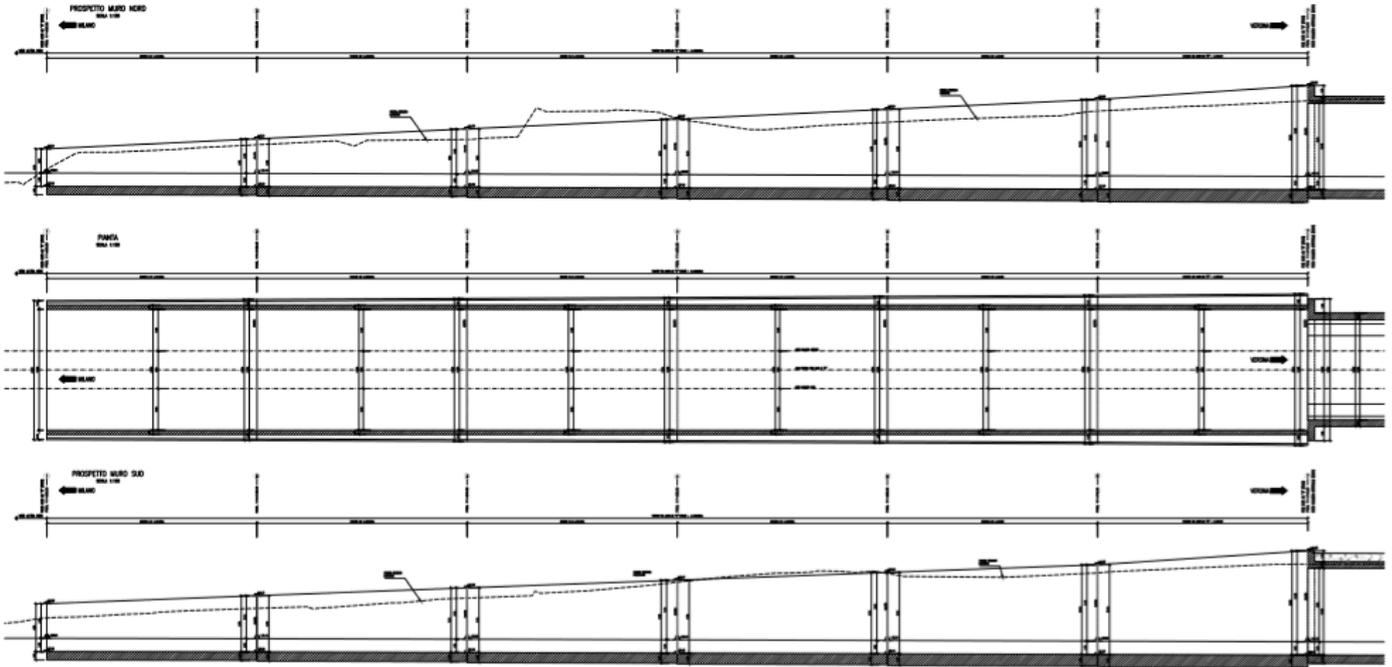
Trincea tra muri ad “U” TR03 – Pianta e Sezione longitudinale
